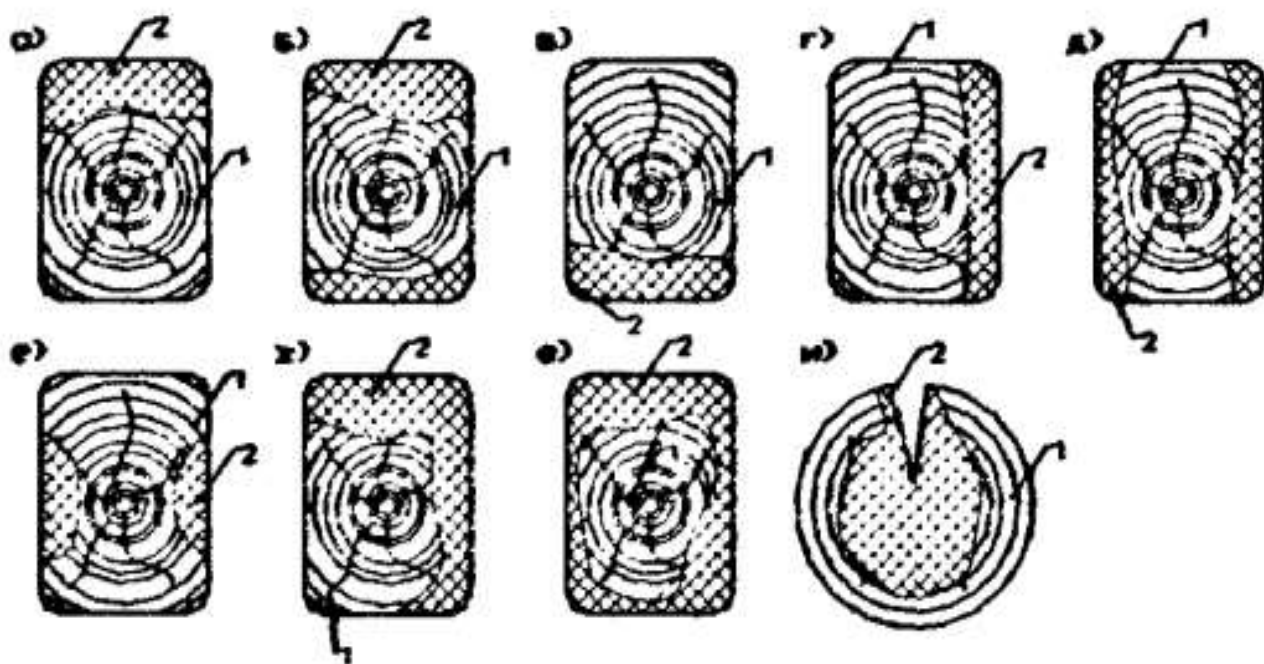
Расположение биоповрежденных участков по длине балок перекрытий (а–в) и верхних поясов стропильных конструкций (г–е).
